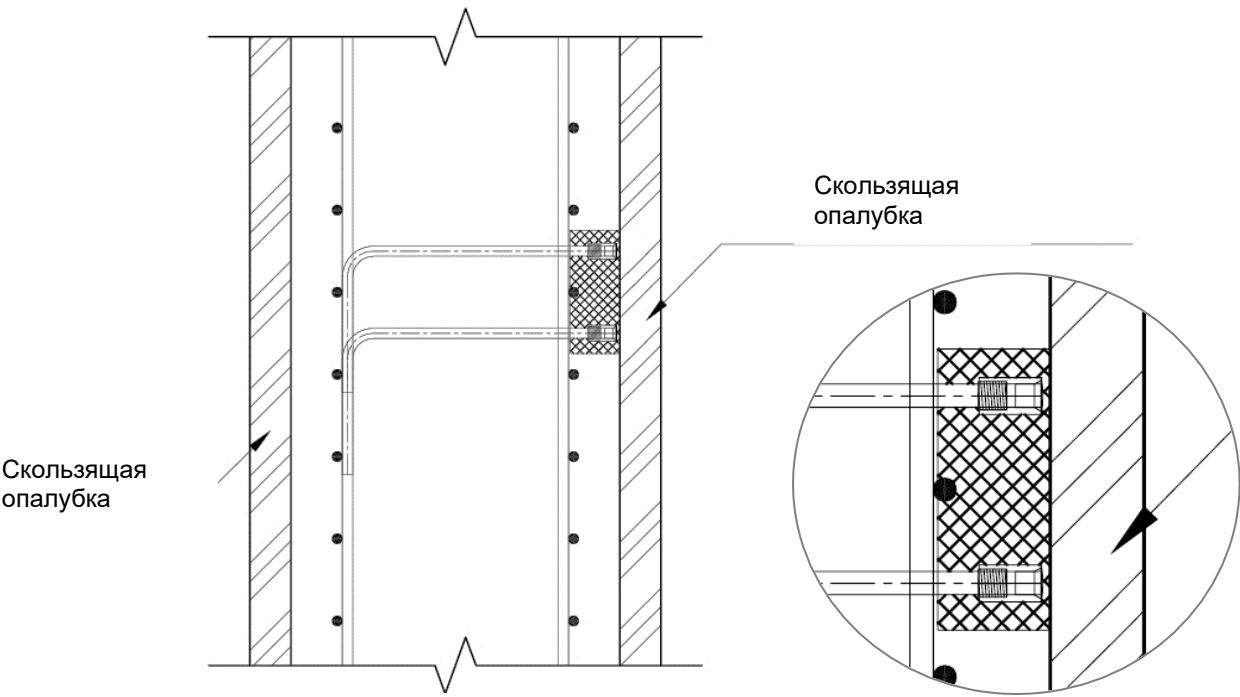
Установка и подъем скользящей опалубки
